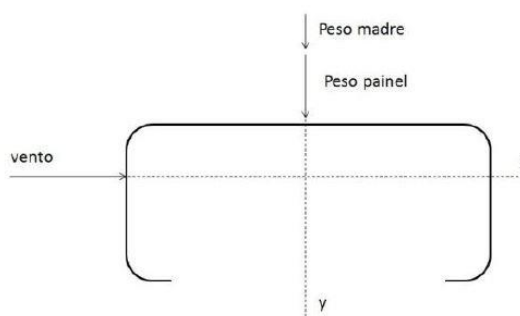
Esquema do perfil da madre de fachada e atuação das cargas
